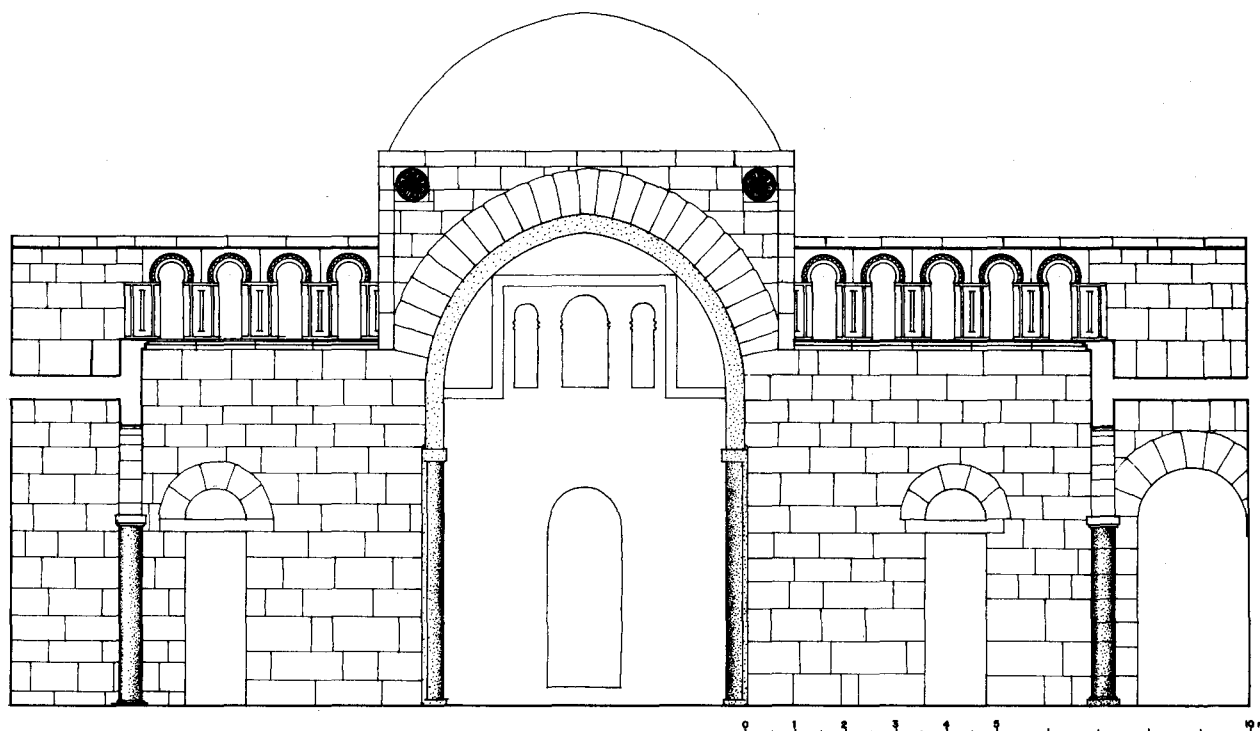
Alzado reconstruido del iwān del área norte.
